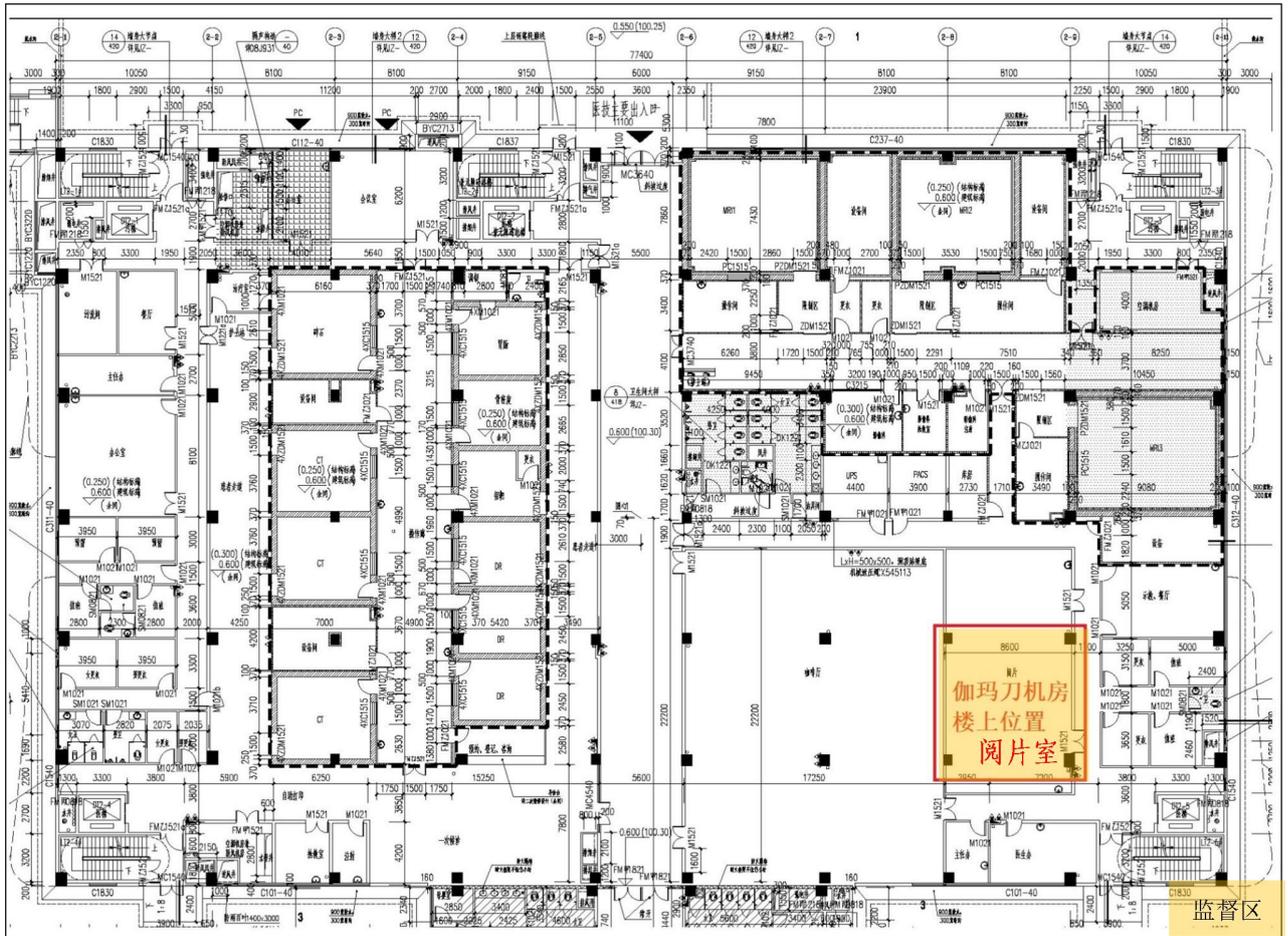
伽玛刀机房上方门诊医技楼一楼平面图
